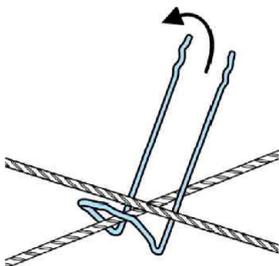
Anstecknadel unter den oberen Bewehrungsstab führen und in senkrechte Lage schwenken.
